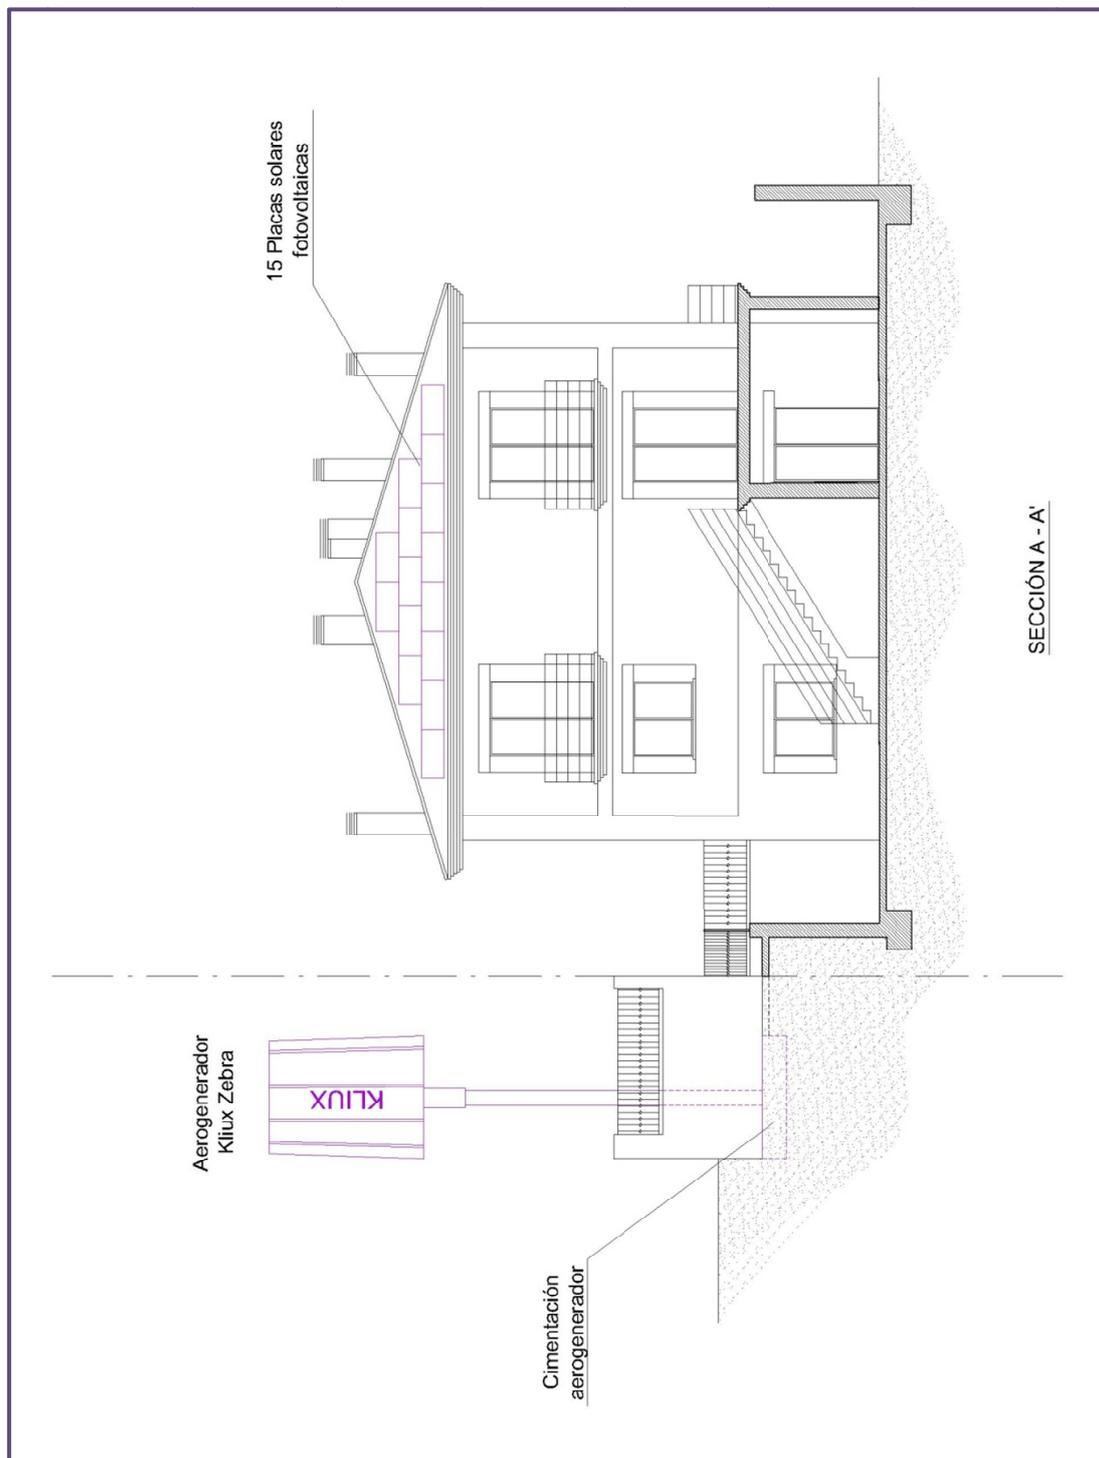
Sección A-A' - ubicación elementos exteriores Kliux
